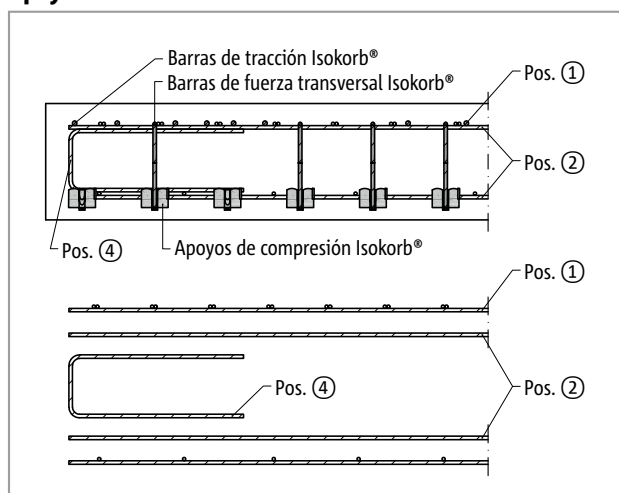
Schöck Isokorb® T tipo K-M1 hasta M11: Armadura in situ del lado del balcón en la sección A-A; pos.4 = refuerzo constructivo en el borde libre perpendicular al Schöck Isokorb®
